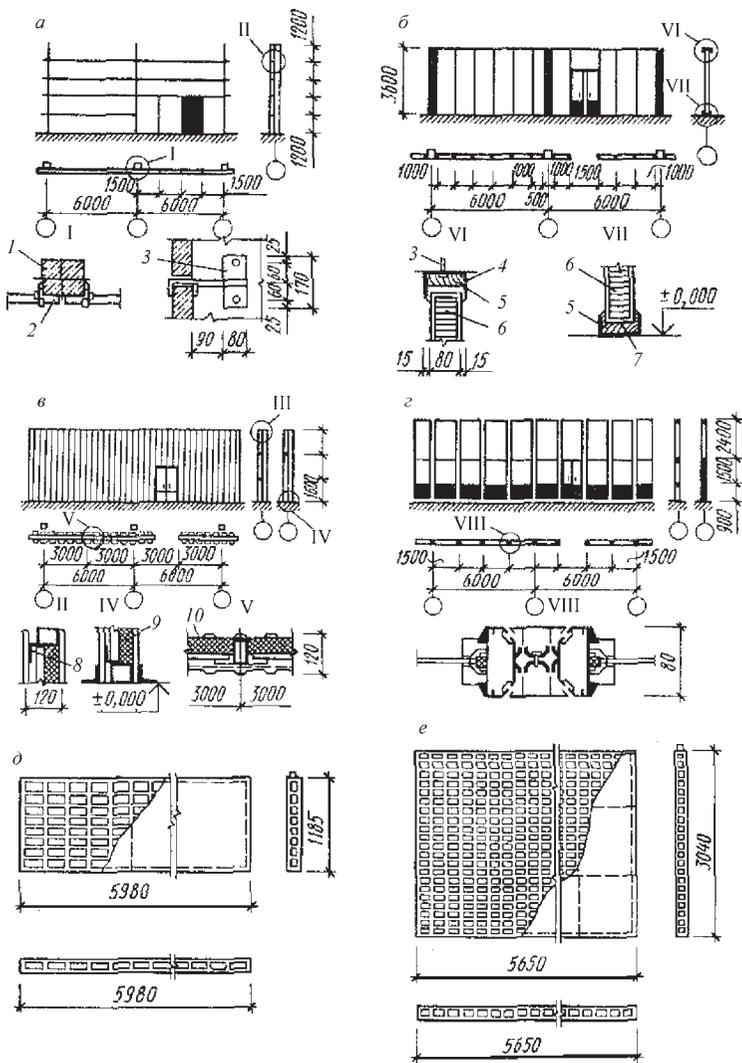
Конструкции сборных перегородок: *а* – железобетонных панельных; *б* – стекло-гипсовых; *в* – из стального профилированного настила; *г* – алюминиевых панельных для герметизированных помещений; *д*, *е* – то же, кирпичных панельных перегородок одно- и многоэтажных зданий; 1 – колонна; 2 – панели-перегородки; 3 – дюбель; 4 – гнутый профиль; 5 – деревянный брус; 6 – стеклогипсовая панель; 7 – герметик; 8 – угловой профиль; 9 – утеплитель; 10 – стальной профилированный лист
